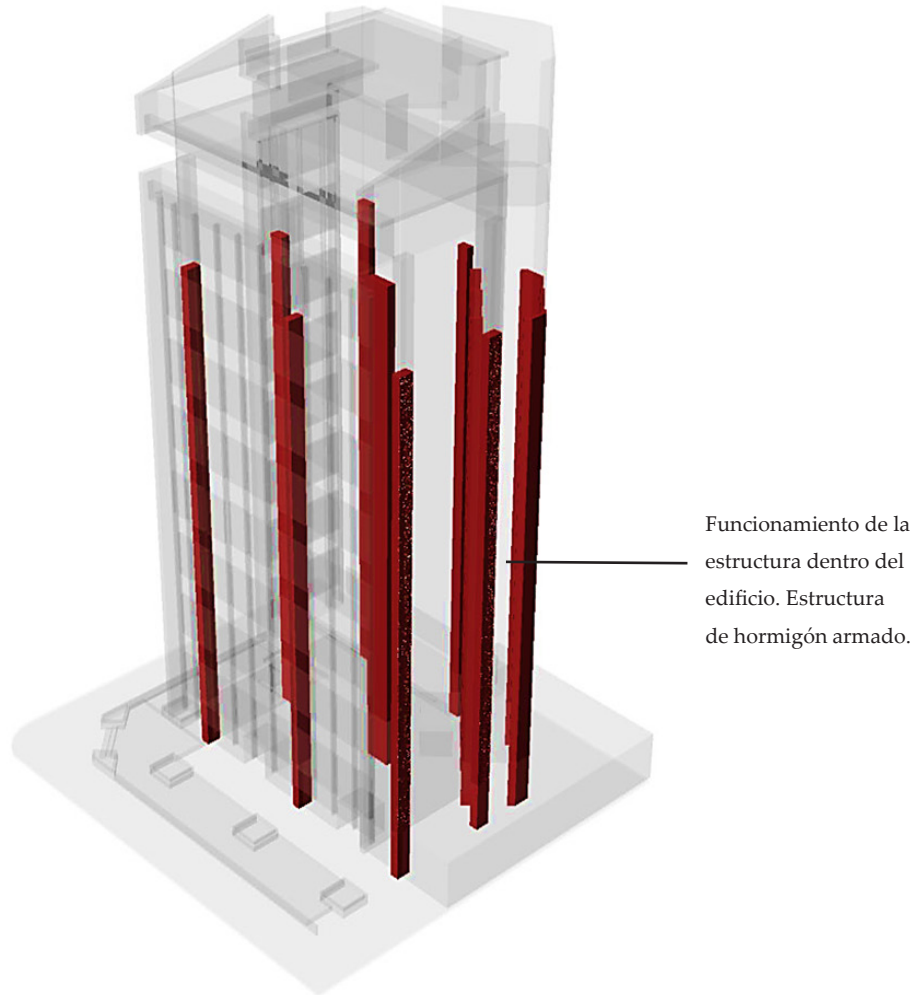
ESTOA edificio “El Ejecutivo”. Estructura de hormigón armado.
